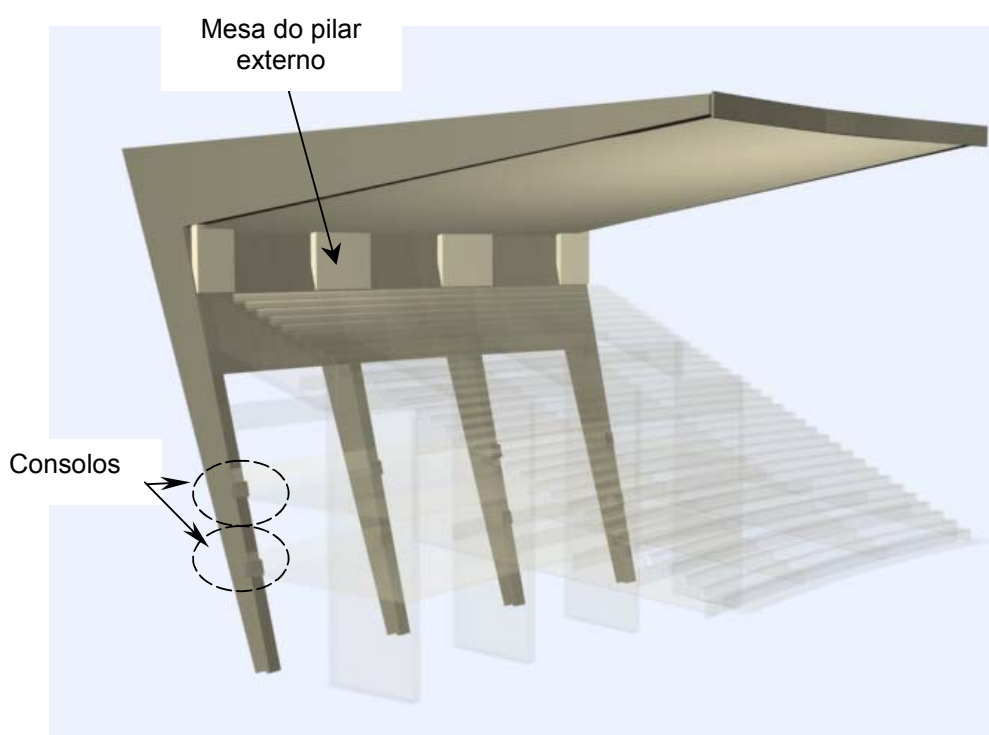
Croquis da estrutura do pilar externo mostrando a seção em forma de T na região entre a viga da arquibancada e a cobertura
